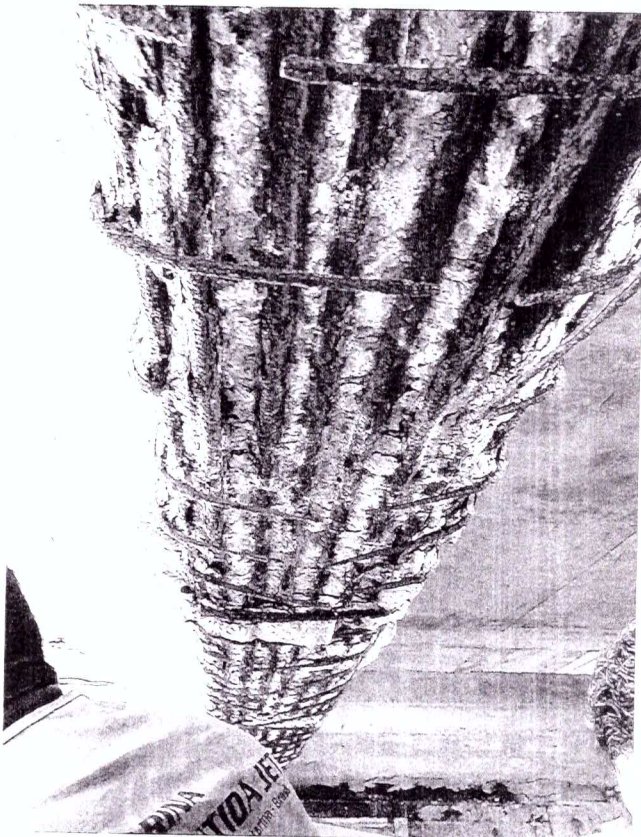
Longarina: ferragem longitudinal exposta e estribos rompidos
